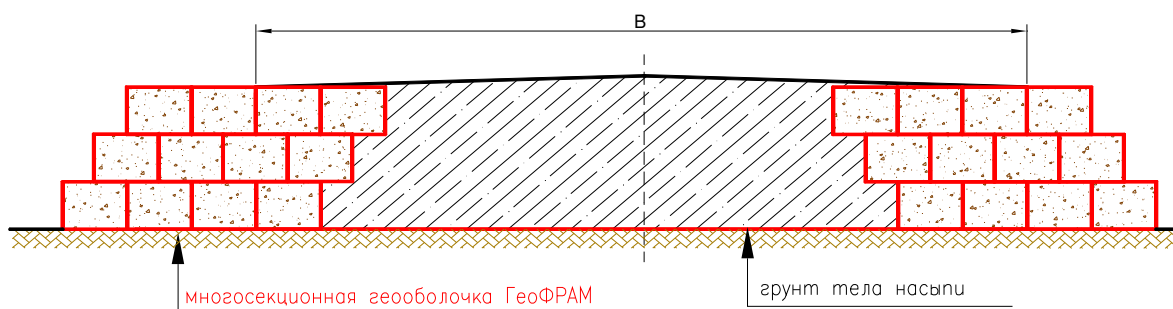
Поперечный профиль автодороги укрепленной армогрунтовыми подпорными стенками из многосекционных геоболочек «ГеоФРАМ»
